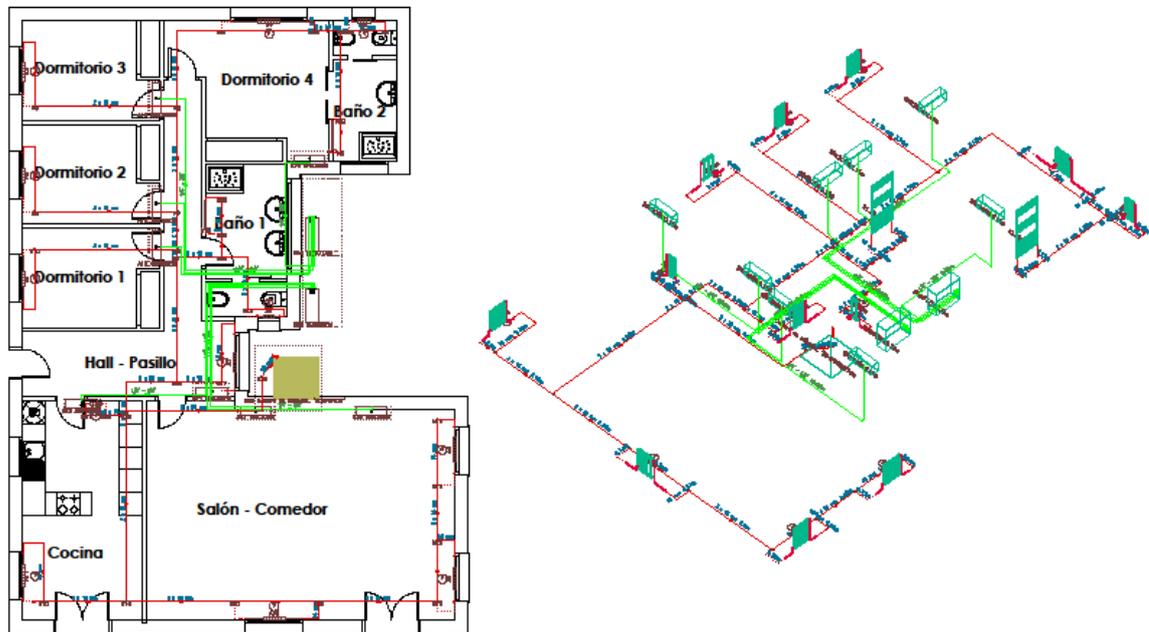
Plano y esquema de planta con instalación con caldera de biomasa
